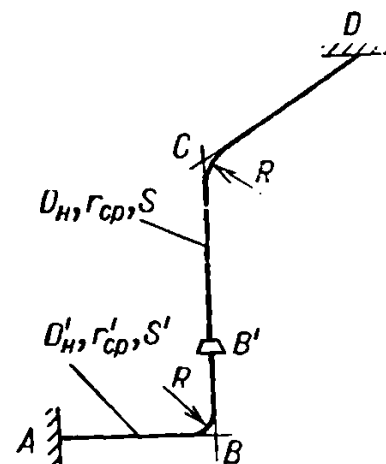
Схема пространственного трубопровода с переходом на другой диаметр
